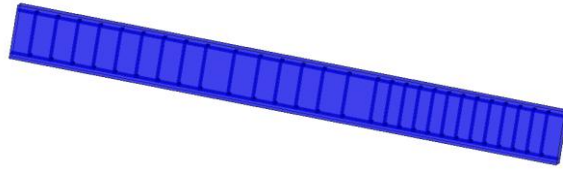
Ensamble de acero y concreto usando elementos SOLID65 y LINK8.
